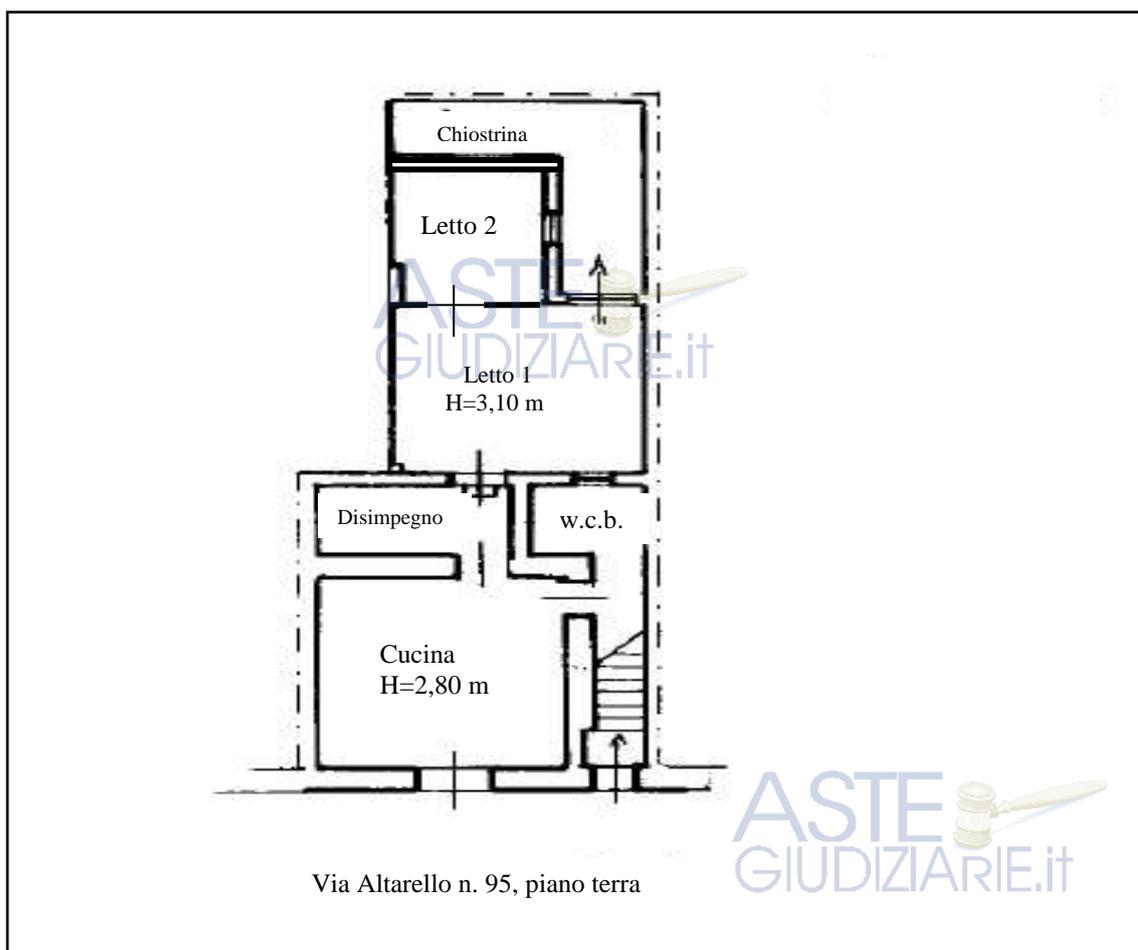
Planimetria stato di fatto, immobile sito in Palermo, Via Altarello n. 95, piano terra
